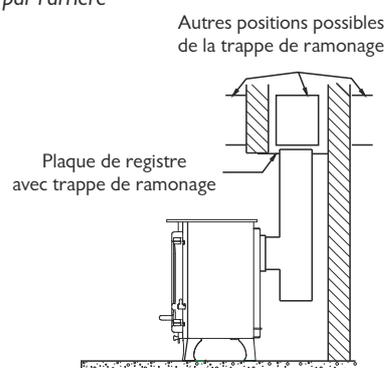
Plaque de registre horizontale avec branchement de conduit de fumée vers le haut
